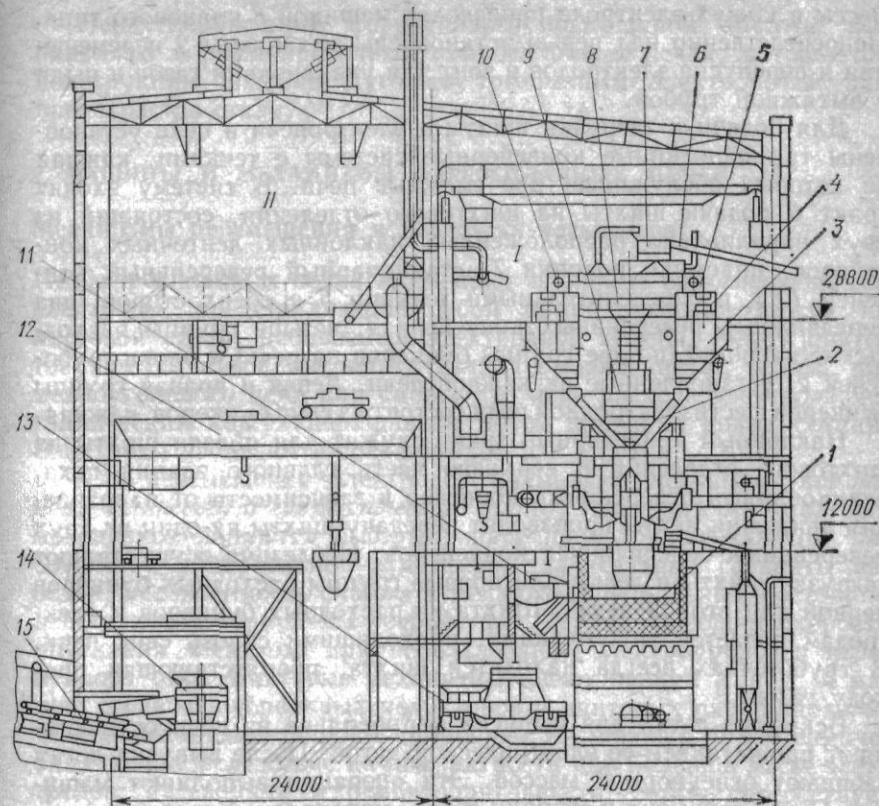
Разрез главного здания ферросплавного цеха
